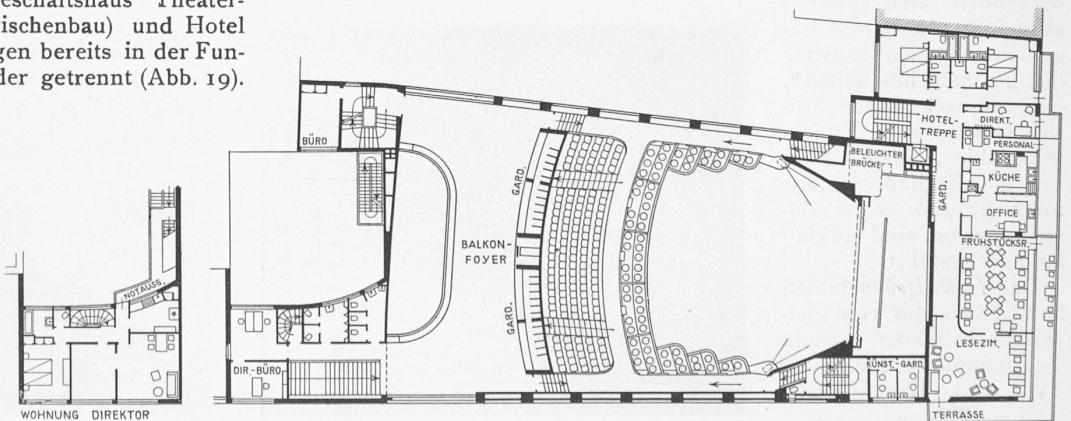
Grundrisse: links II. Stock Zwischenbau, rechts Balkon-Foyer und I. Stock Hotel. — Masstab 1 : 500.
